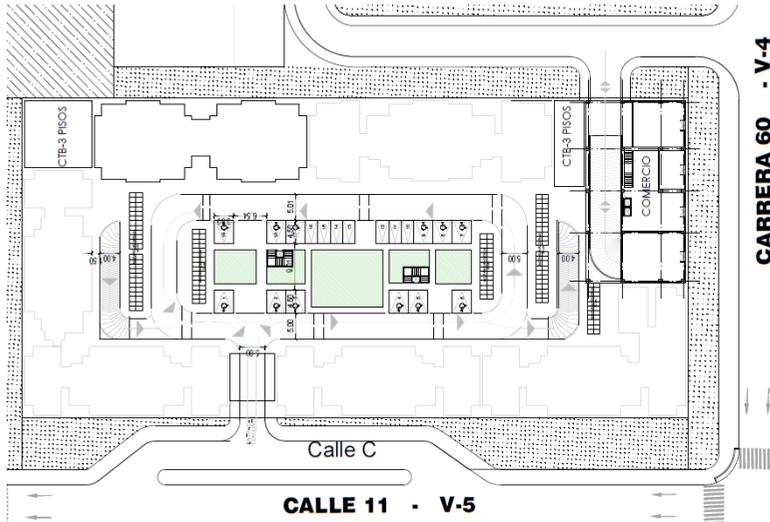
PF13. Planta Estacionamientos – Primer piso
